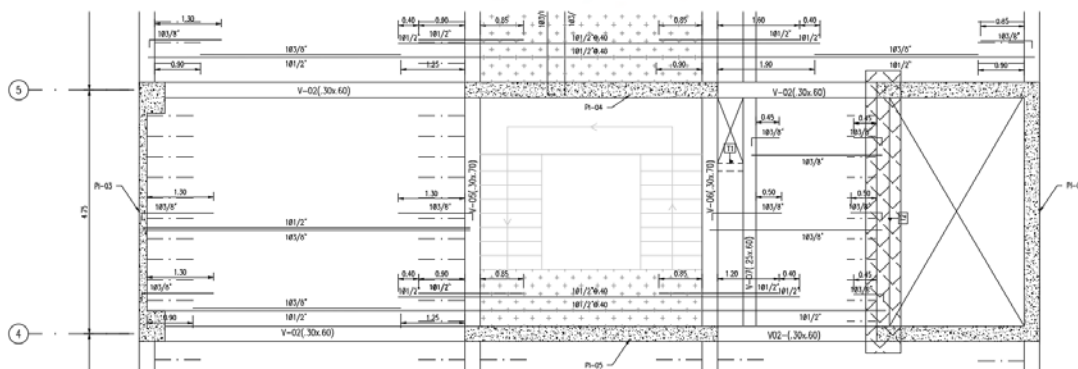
Vista en planta de la viga ubicada en el “eje D”
